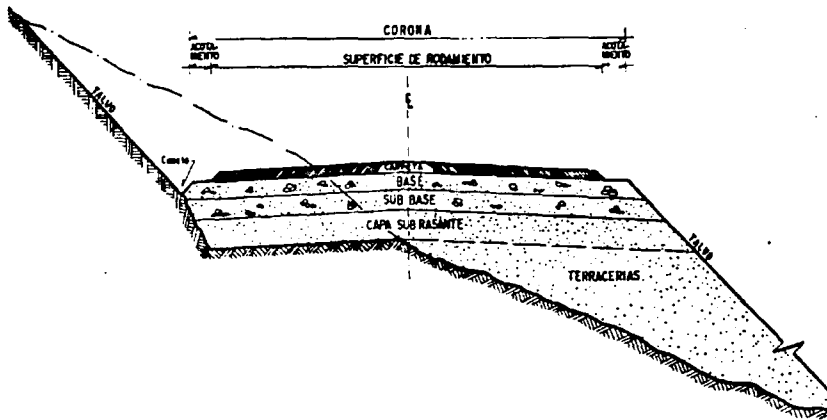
Sección transversal típica de un pavimento flexible en una sección en balcón.
